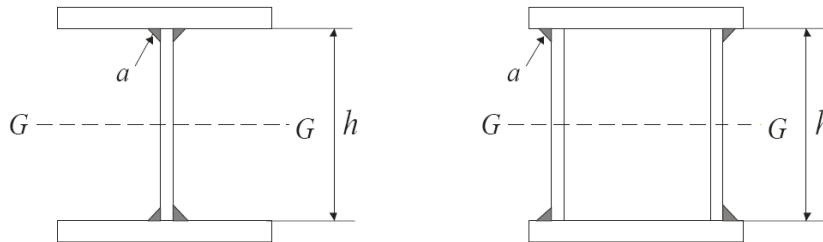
UNIÓN DE ALMAS Y ALAS EN VIGAS ARMADAS
